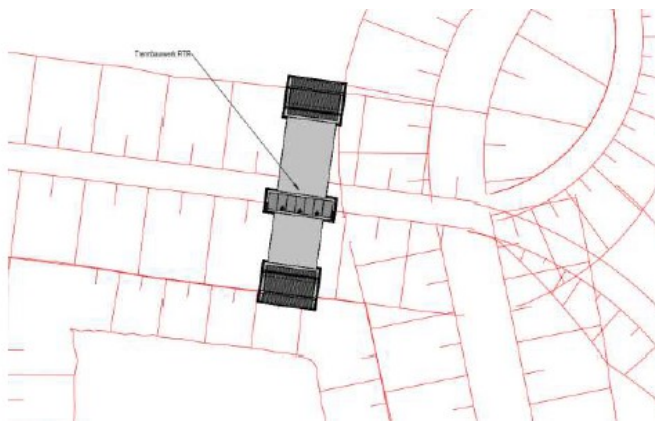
Grundriss des Trennbauwerkes ([13], Kap.7.5.3, Abb.43)
